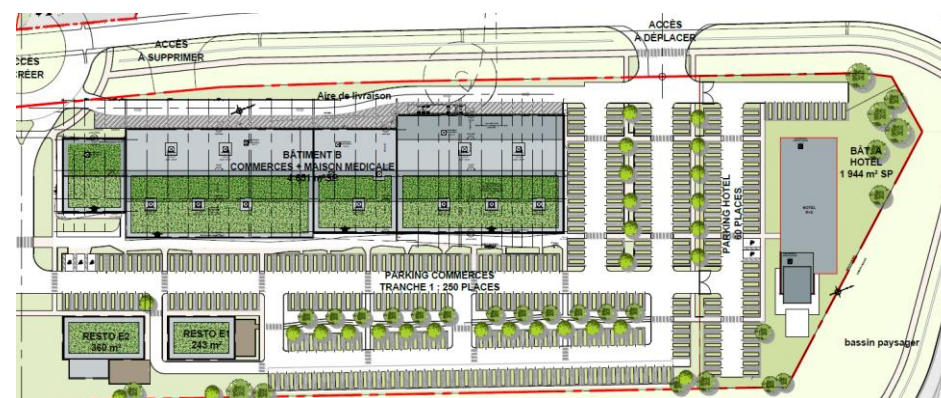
Plan de masse - phase 1 de la zone commerciale (Source : Artchimad, Avril 2022)
